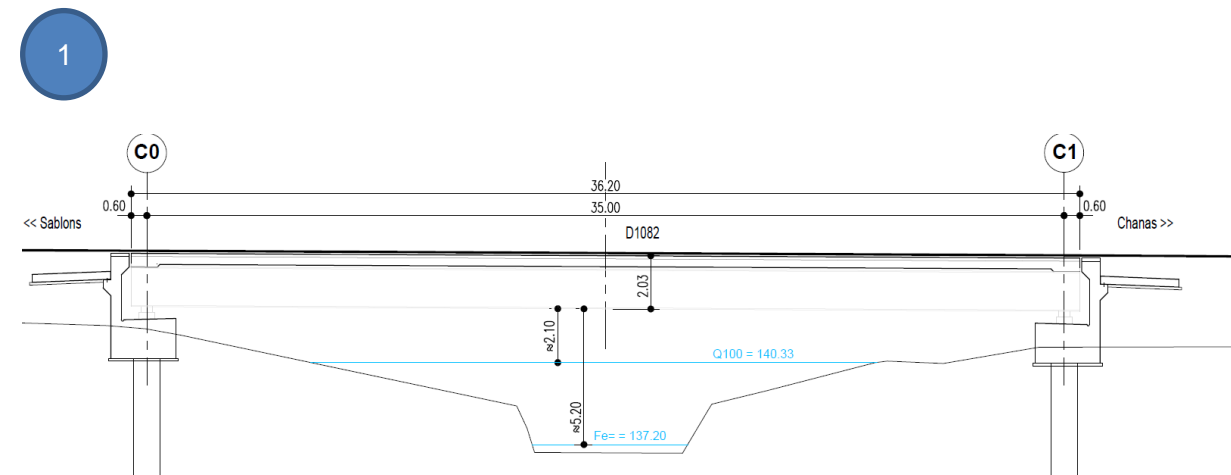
Coupe du franchissement Sud – Ingerop juin 2017
